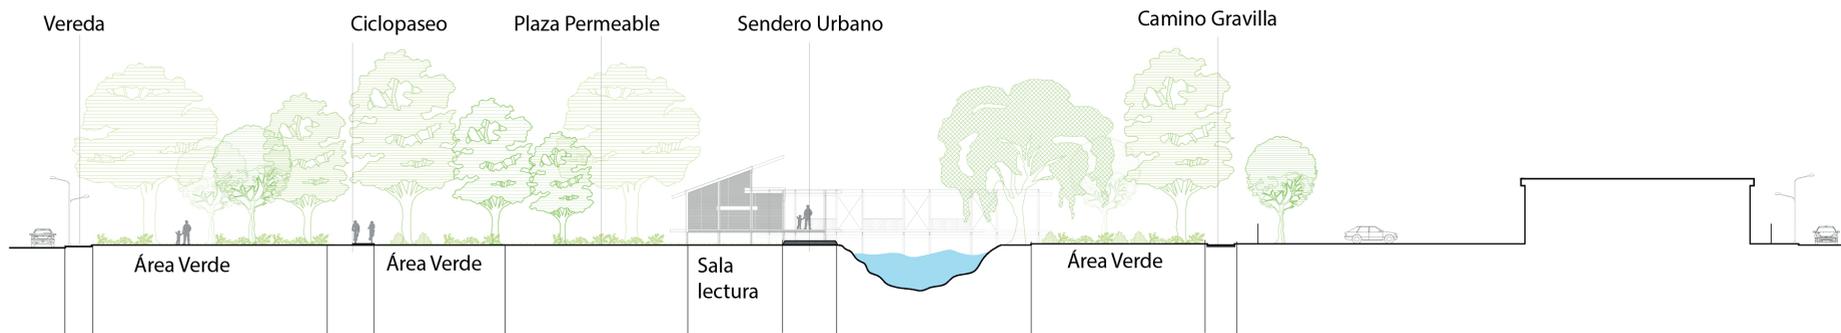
Corte Tramo Quiero Mi Barrio. Fuente: Elaboración propia.
